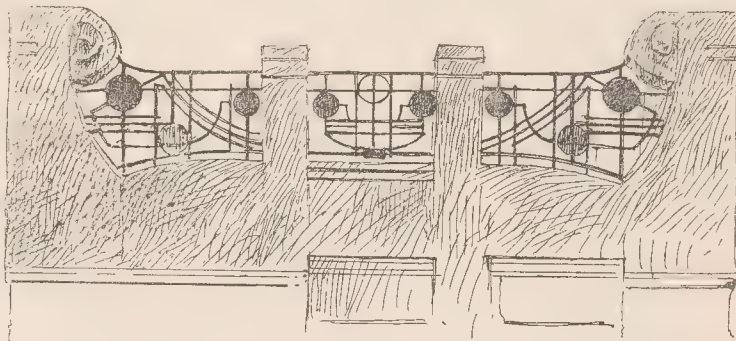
Cortlanzone (Lonigo): Parapetto d'una torre nella Villa Rosa (Alfredo Melani).
